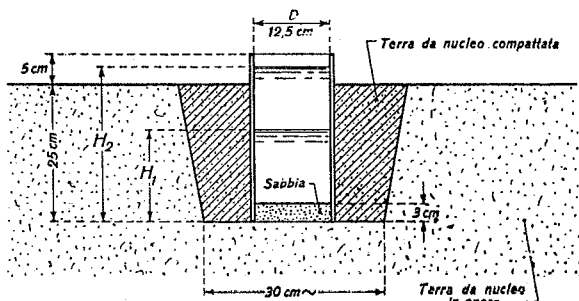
Schema delle prove di permeabilità sul rilevato.
